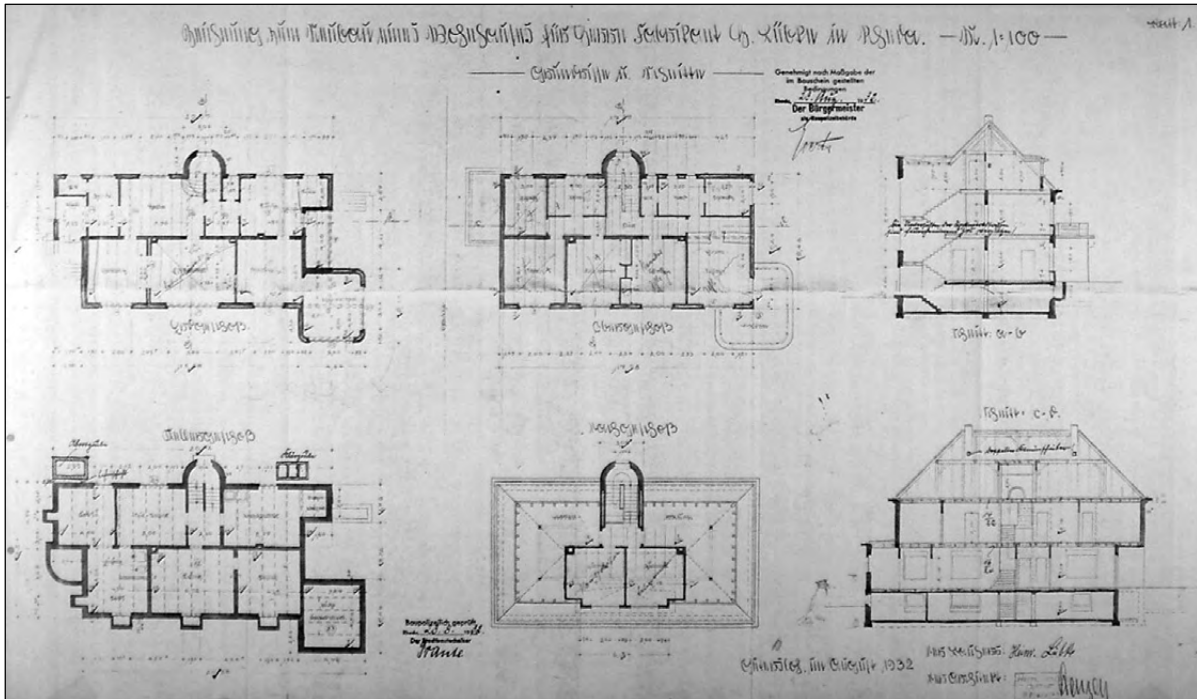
Abb. XXIX Rheda, Wilhelmstraße 11, Grundrisse und Schnitte des Bauantrags
